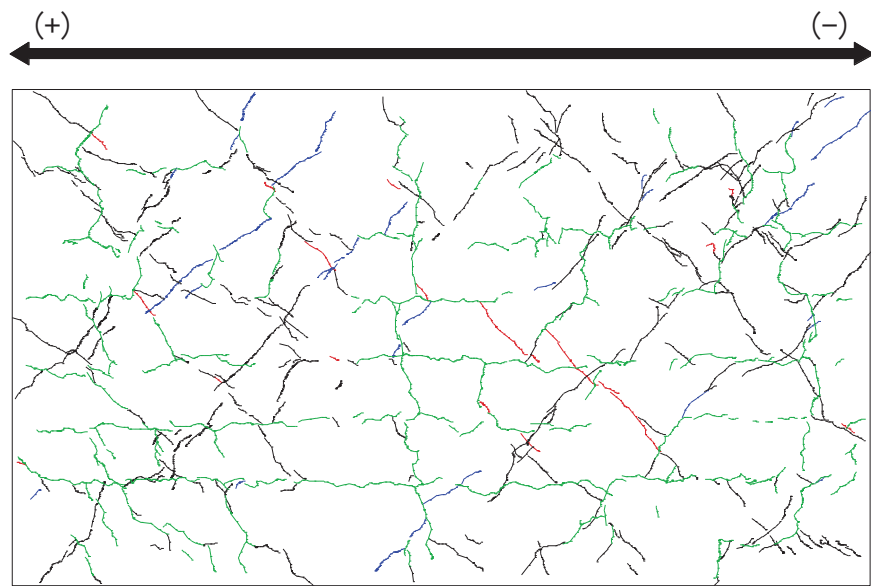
(8) 乾燥試験体 [2] 1/1000rad. におけるひび割れ図
